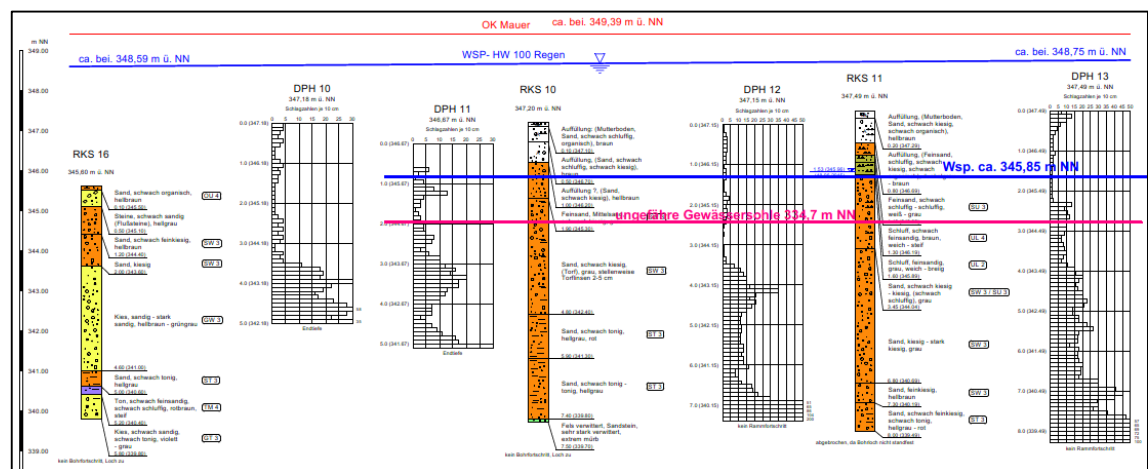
Schnittprofil Anlage 5.5, gemäß Baugrundgutachten
